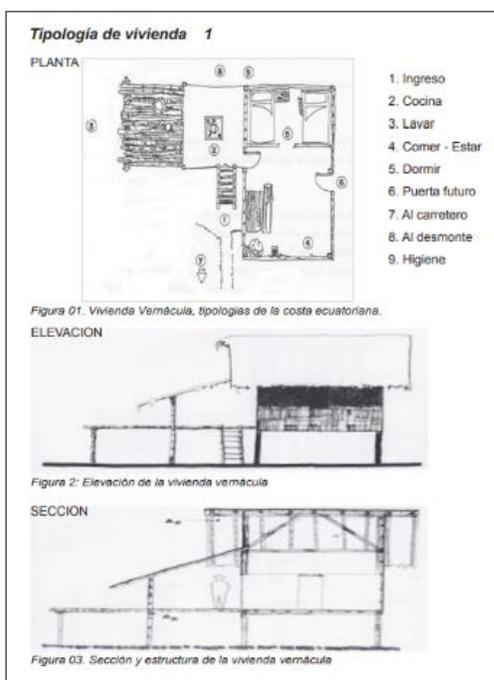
Tipología 01, plantas, cortes y elevaciones
